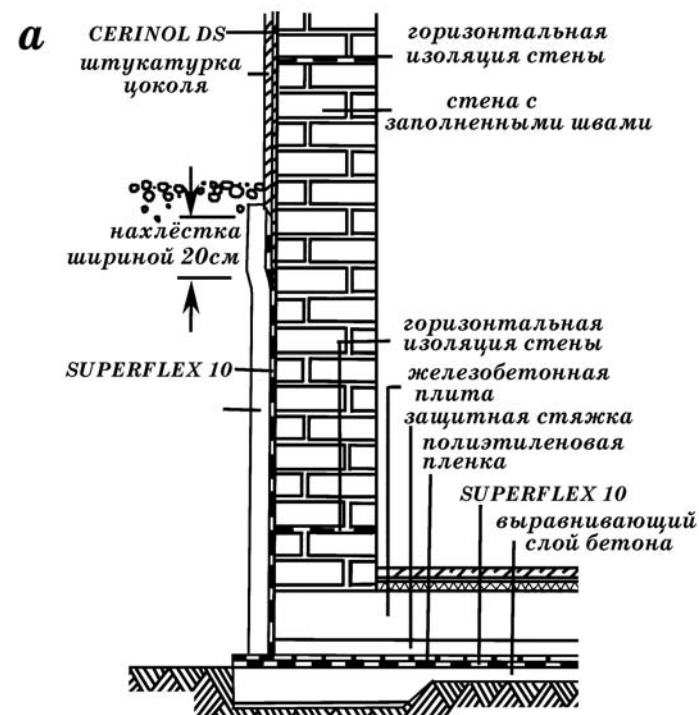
Конструктивная схема выполнения гидроизоляции: а — гидроизоляция основания дома с подвалом
